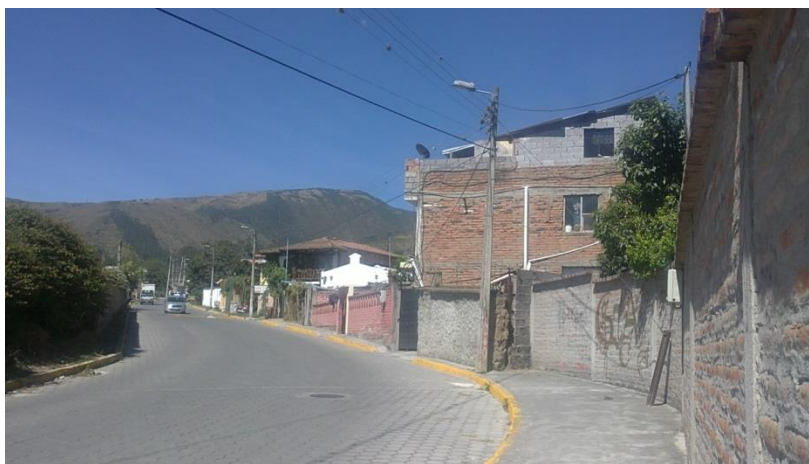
Calle Guagrahuma que pasa junto a la vivienda.
